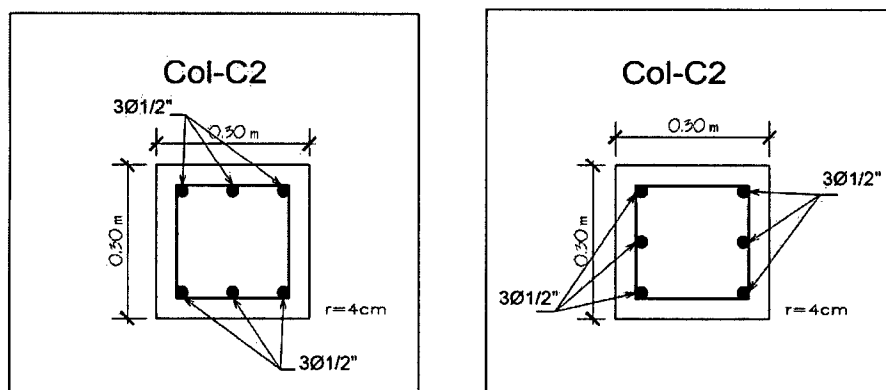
Distribución de refuerzo en cada uno de los lados de la columna C2.
